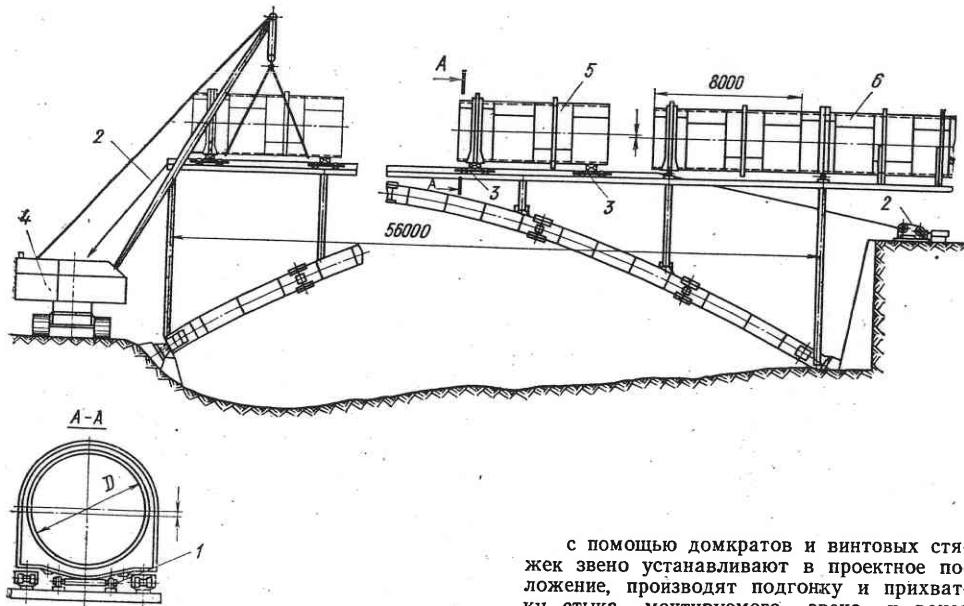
Монтаж трубопровода на акведуке, не попадающем в зону действия крана:
